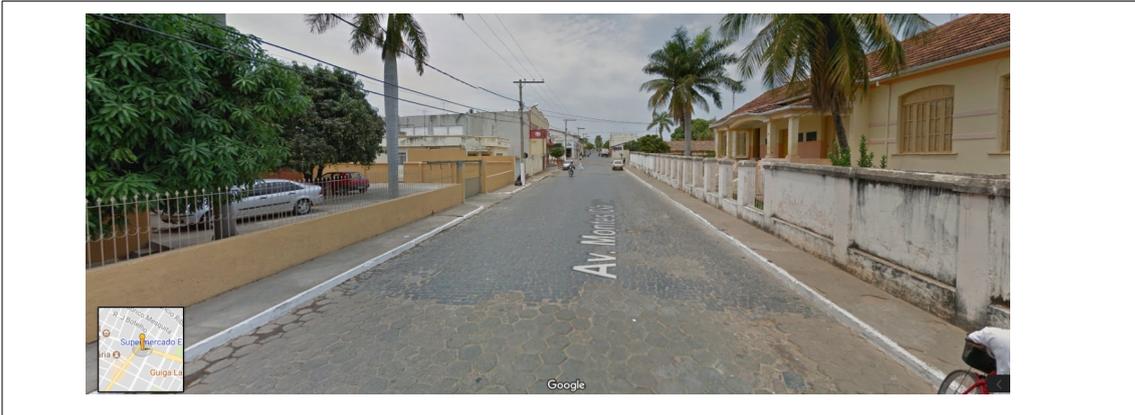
Avenida Montes Claros, entre as avenidas Oscar Caetano e Presidente Juscelino. Pavimentação em blocos de concreto intertravado e paralelepípedo.
